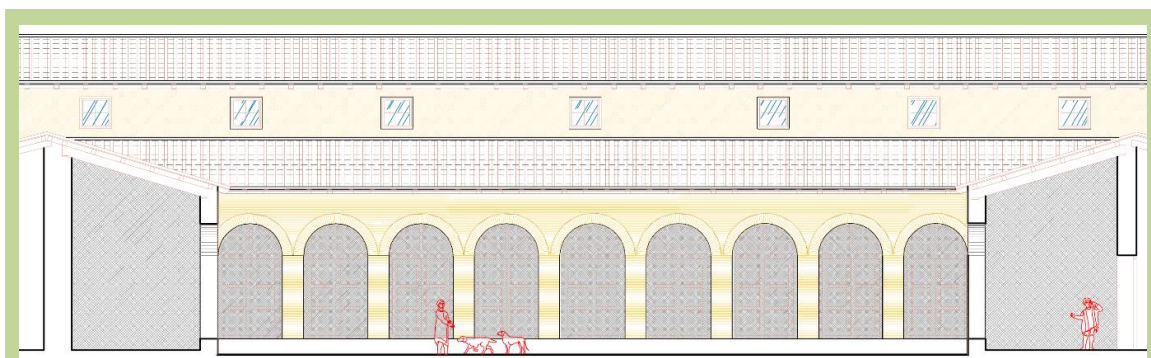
Sección por el patio y en dirección sur. En primer término la fachada reconstruida por anastilosis. CGS.
